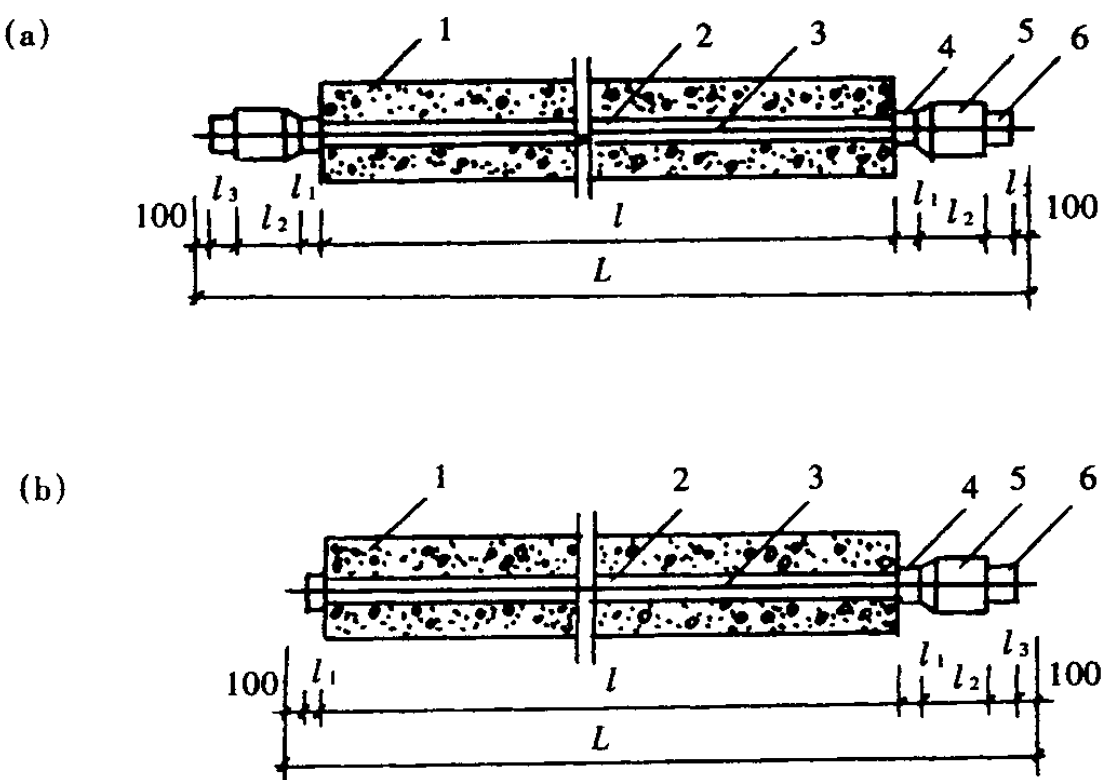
31 钢筋束、钢绞线束下斜长度计算简图
